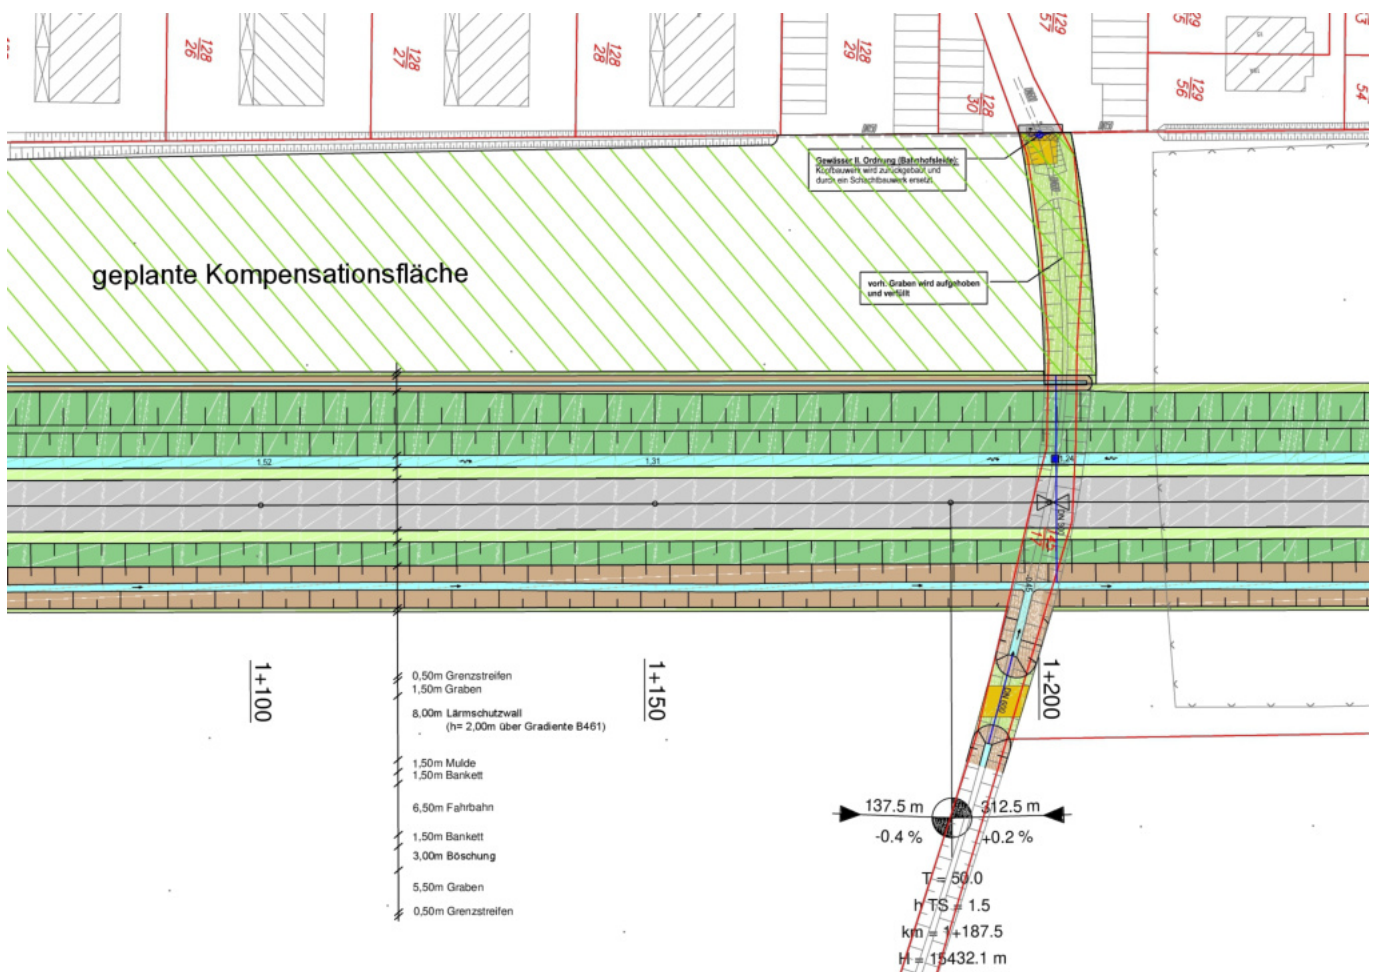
Lageplan zum Feststellungsentwurf, Ausschnitt Bereich Bahnhofsleide (unmaßstäblich)
